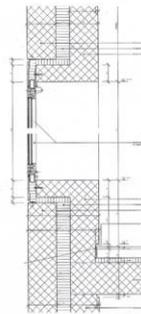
Wandöffnung in einer zweischaligen Sichtbetonkonstruktion
